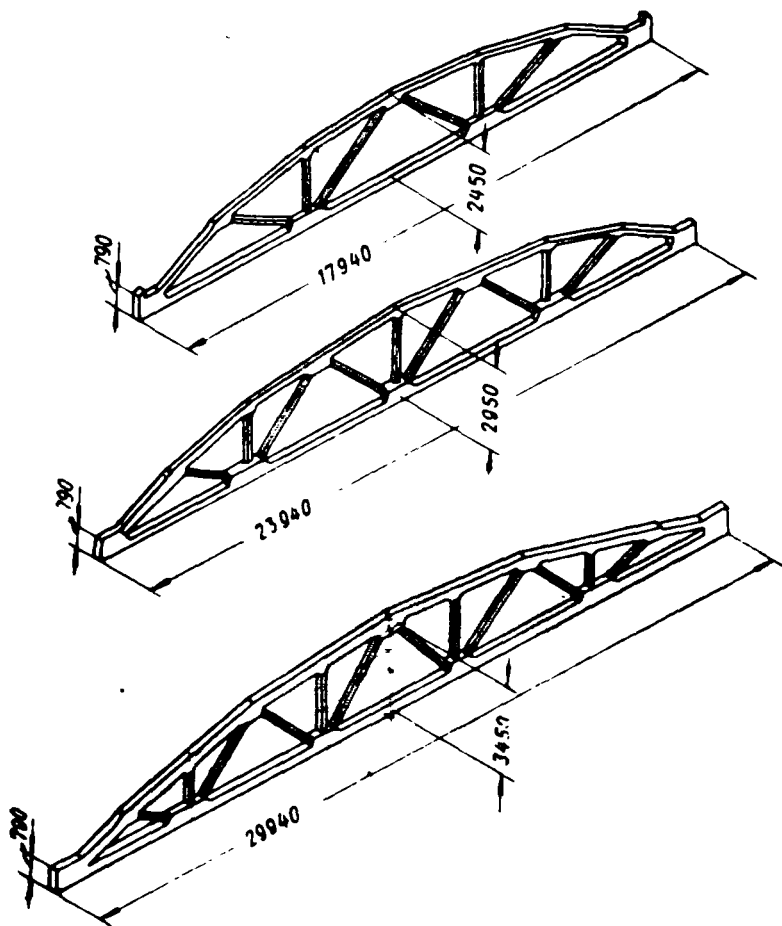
Типовые предварительно напряженные сегментные фермы серии ПК-01-129
